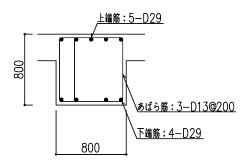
大ばりの配筋図 (屋上階, X2通り YK~YL 通り間,端部) (単位:mm)
